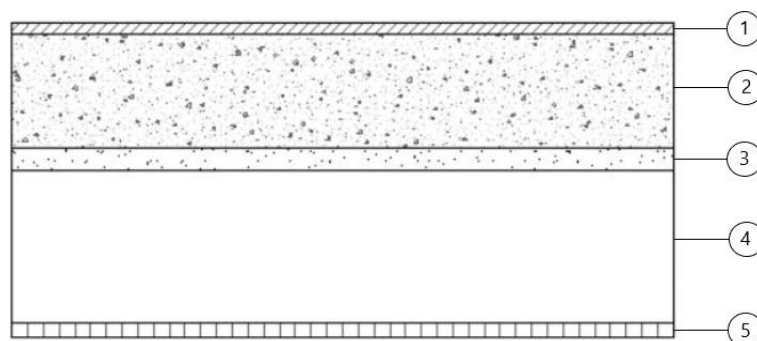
Pormenor da constituição da cobertura das instalações sanitárias
